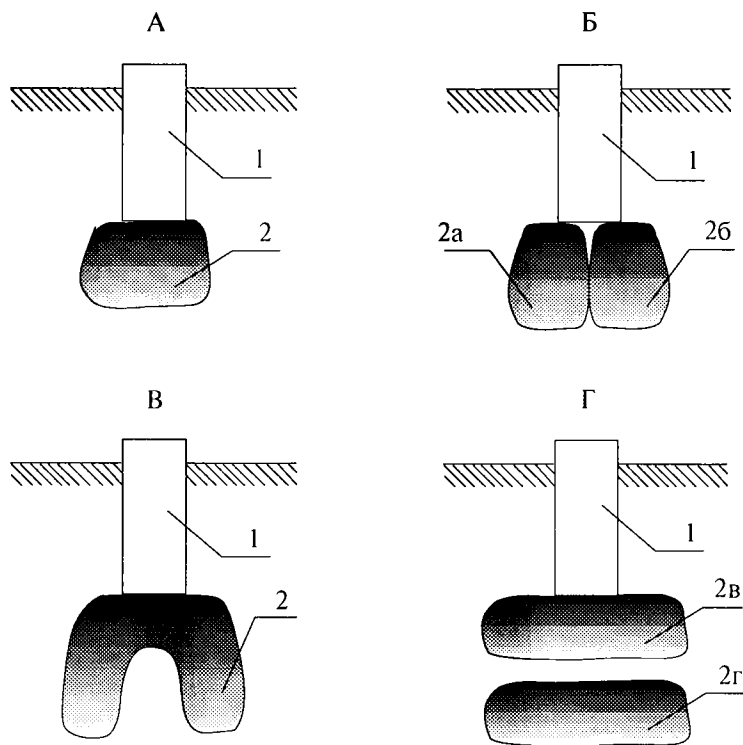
Схемы устройства оснований из закрепленного грунта
